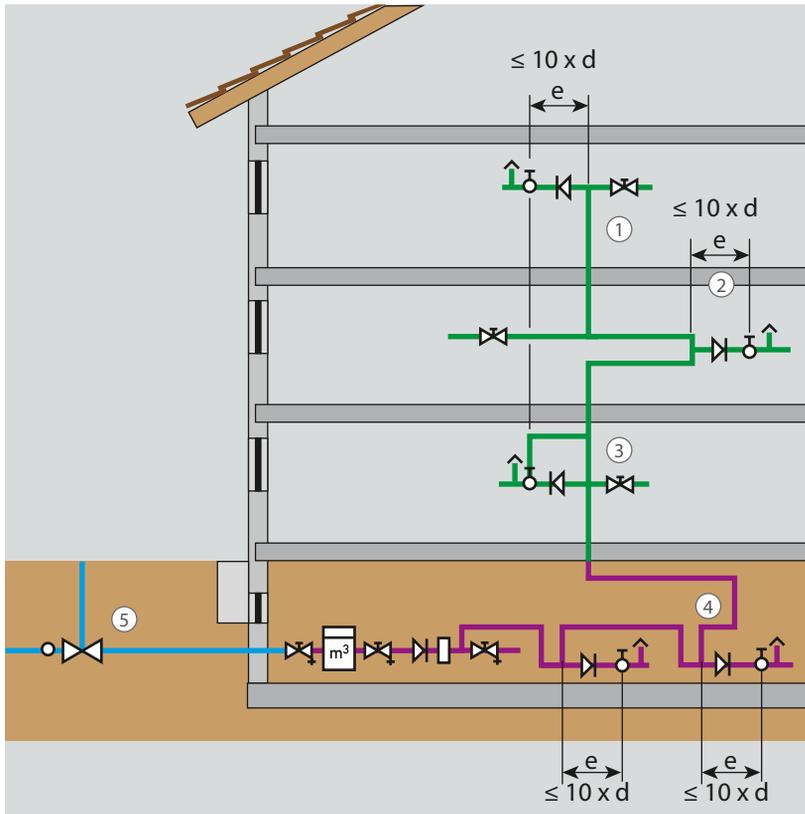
Trinkwasser-Installation mit Wandhydranten
